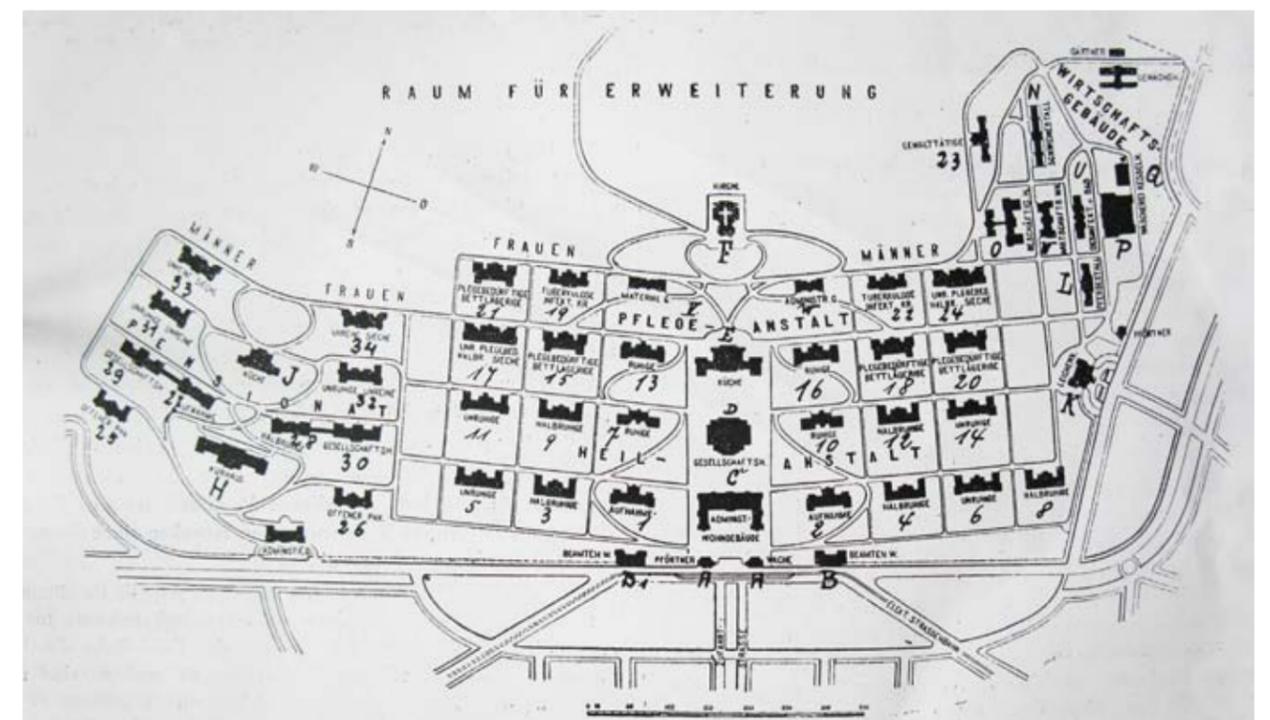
Lageplan Steinhof Entwurf Otto Wagner „Künstlerentwurf“
